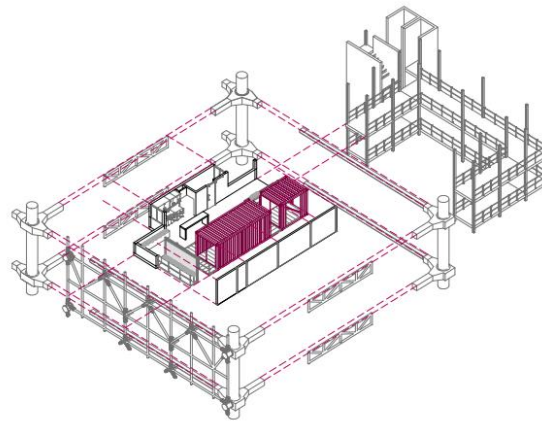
Axonometría despiece, tipología 5, elaboración propia
